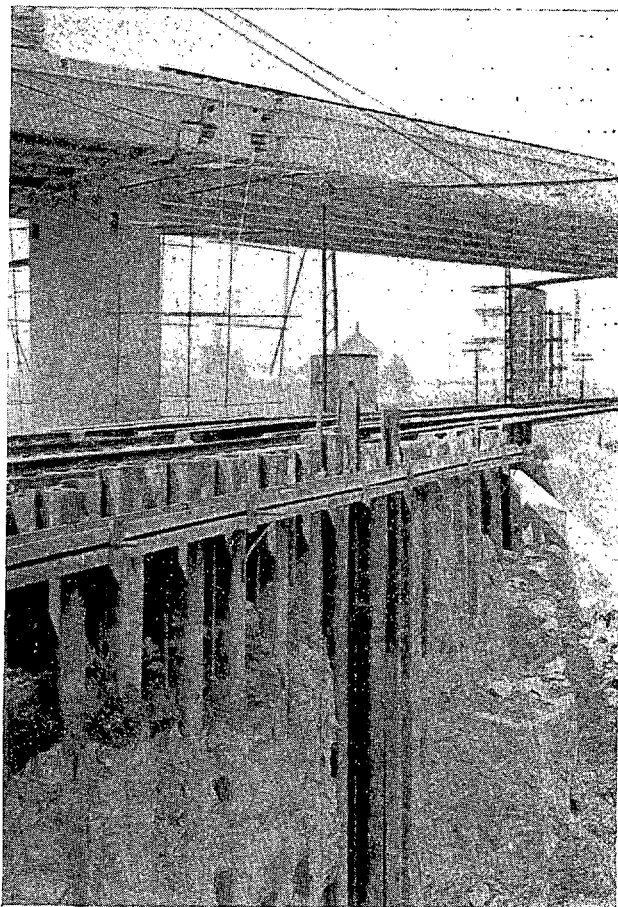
Cortes de terraplenes del ferrocarril realizados con tablestacas en las autopistas de Barcelona a La Junquera.
